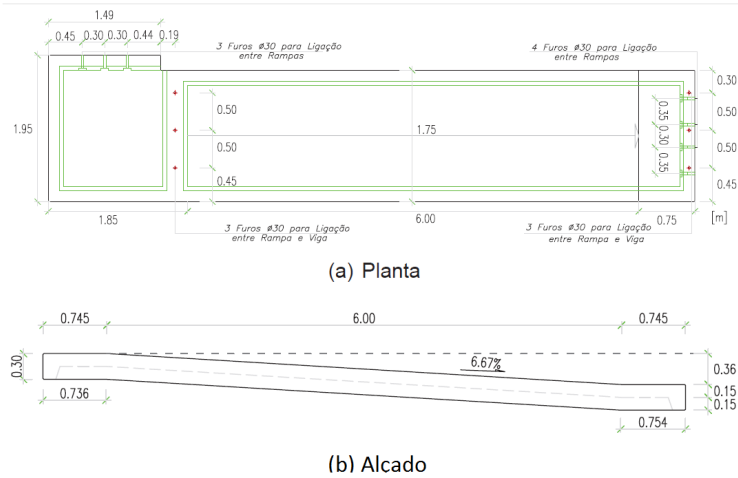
Pormenor da rampa em planta e em alçado [33].
